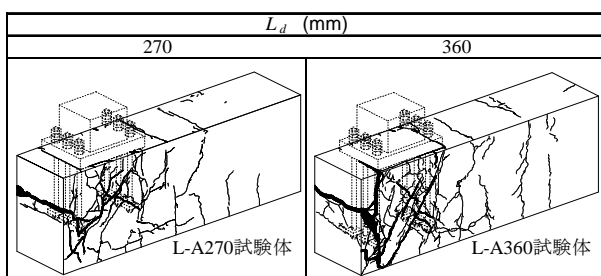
ひび割れ状況 ($R = \pm 1.5\%$)
